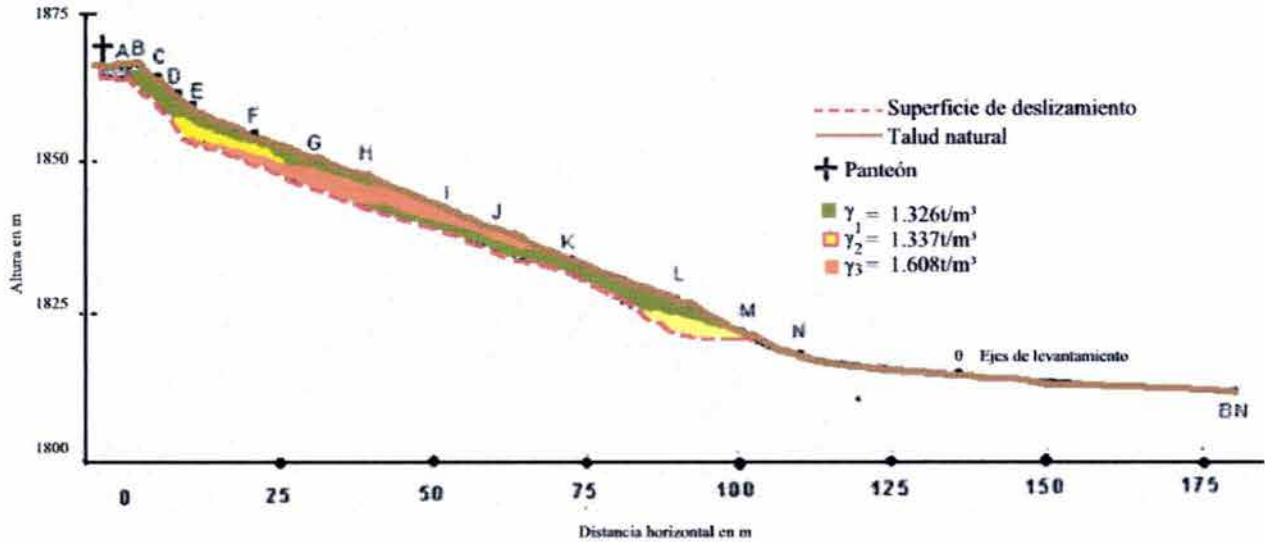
Perfil del deslizamiento “La Aurora” por su eje longitudinal. Ref.
